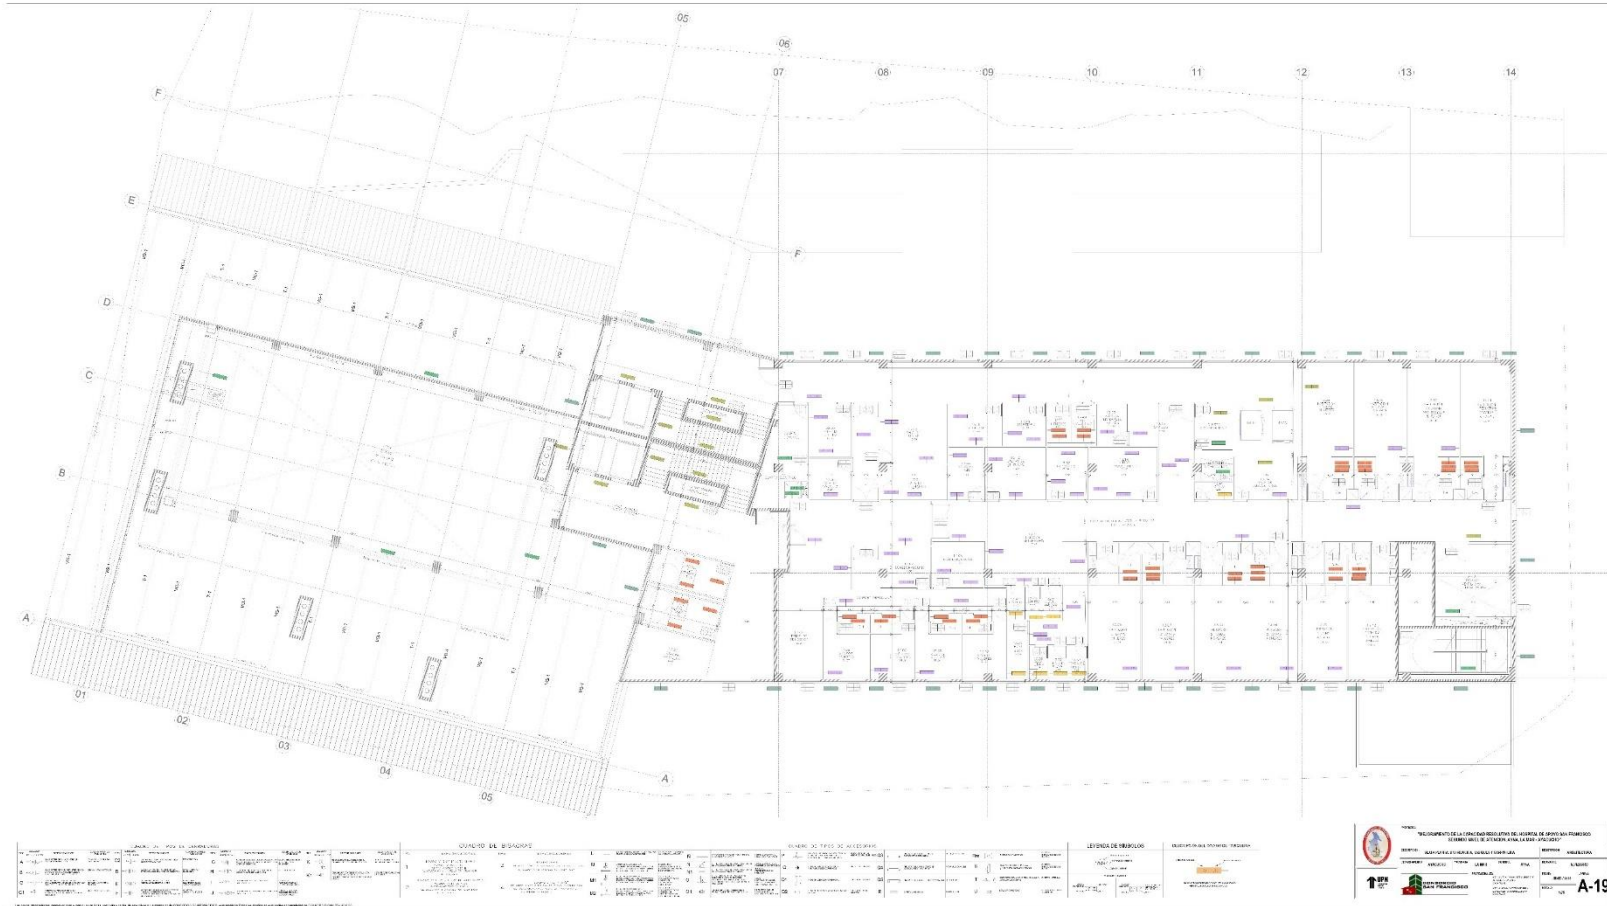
QUINTA PLANTA DISTRIBUCION
